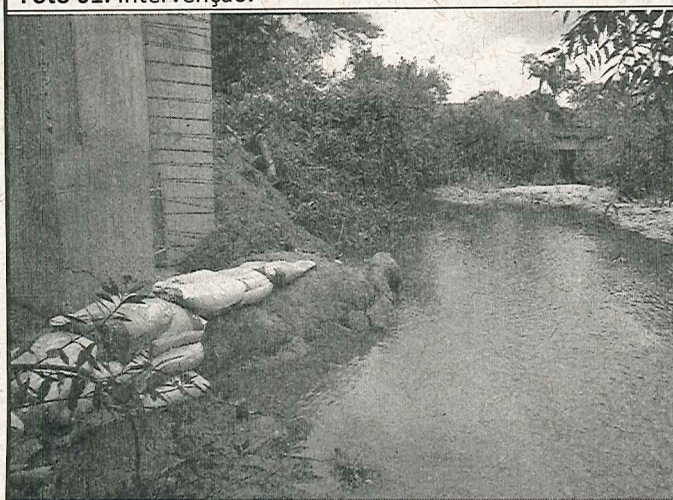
Intervenção na margem do Córrego Chiqueiro.
